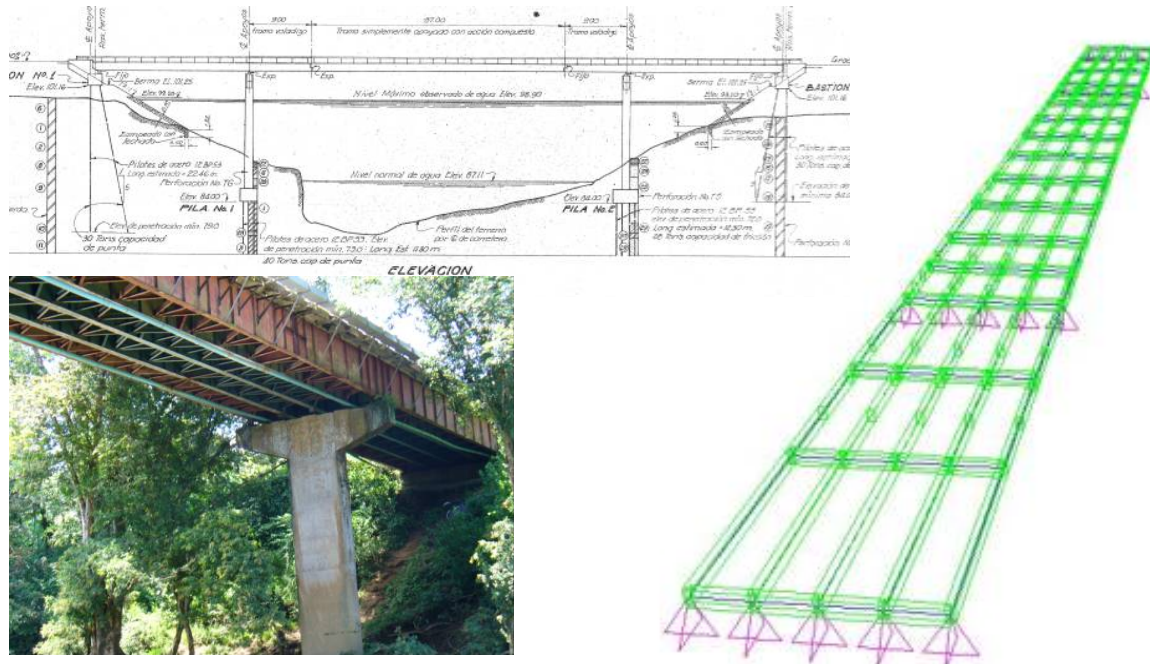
Modelo Estructural para el Puente de Vigas Múltiples de Acero
